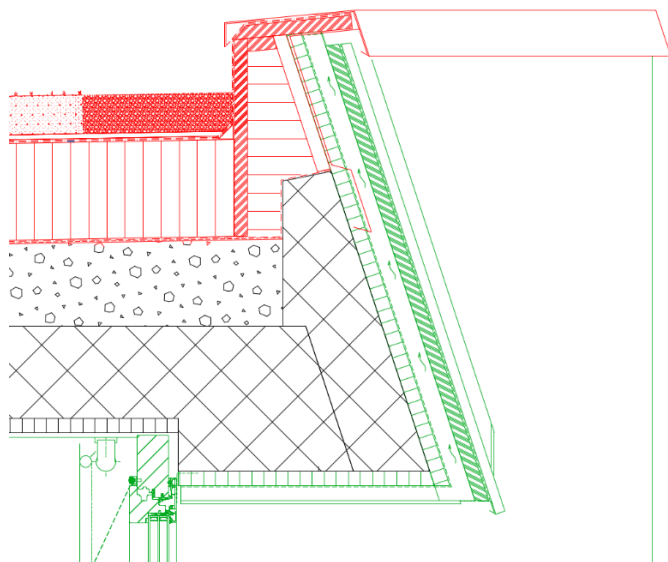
BZWU Dachranddetail / rot aktuell geplant / grün mögliche nachträgliche Fassadensanierung
